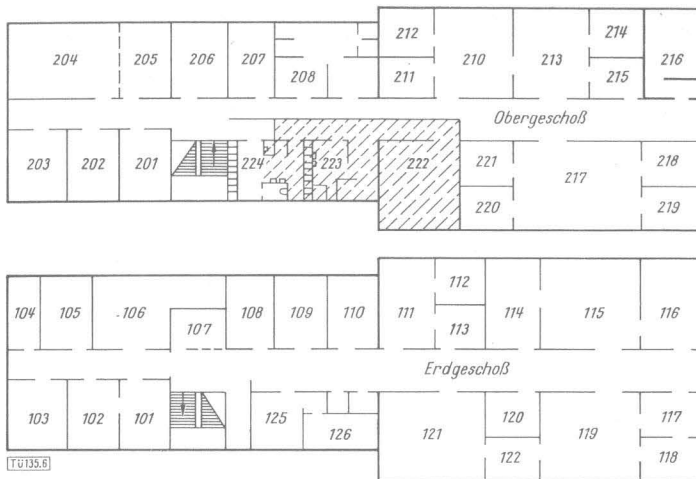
Grundriß. Die Zone möglicher Kontamination ist schraffiert.
